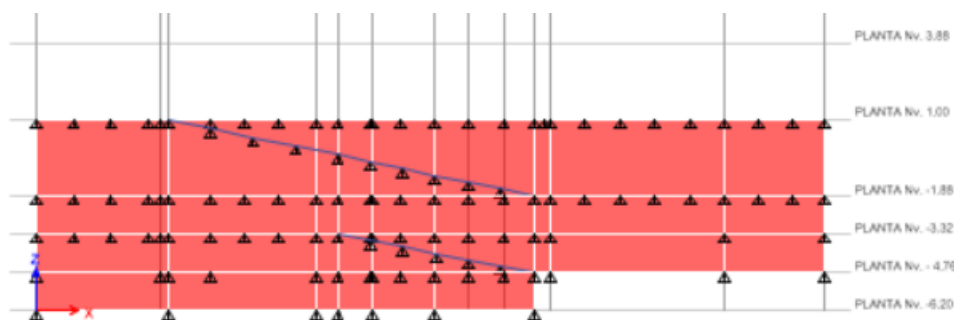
Vista lateral de los muros subterráneos con los apoyos de las vigas apoyadas
